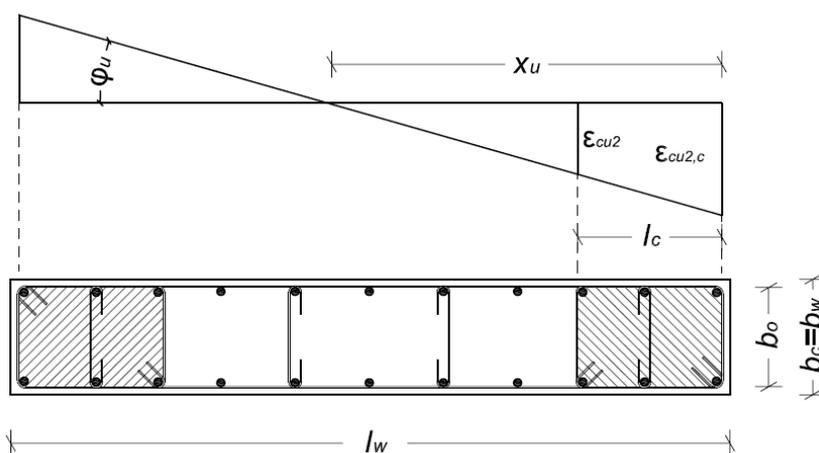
Elementi di bordo di una parete, diagramma delle corrispondenti curvature, schema esemplificativo delle armature di confinamento
